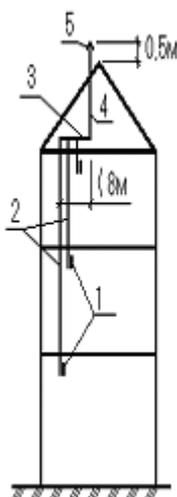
Схема вытяжной естественной канальной вентиляции малоэтажного здания
